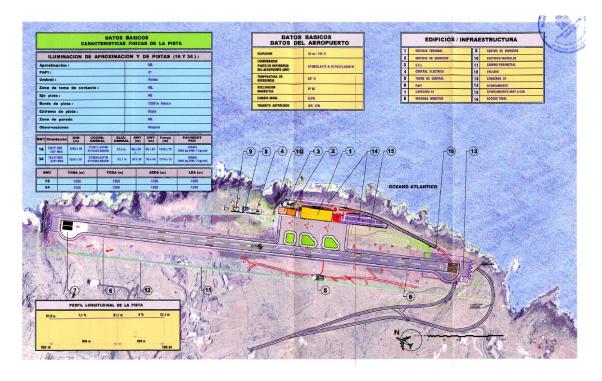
Ubicación y plano de aeropuerto de El Hierro. Fuente AENA
